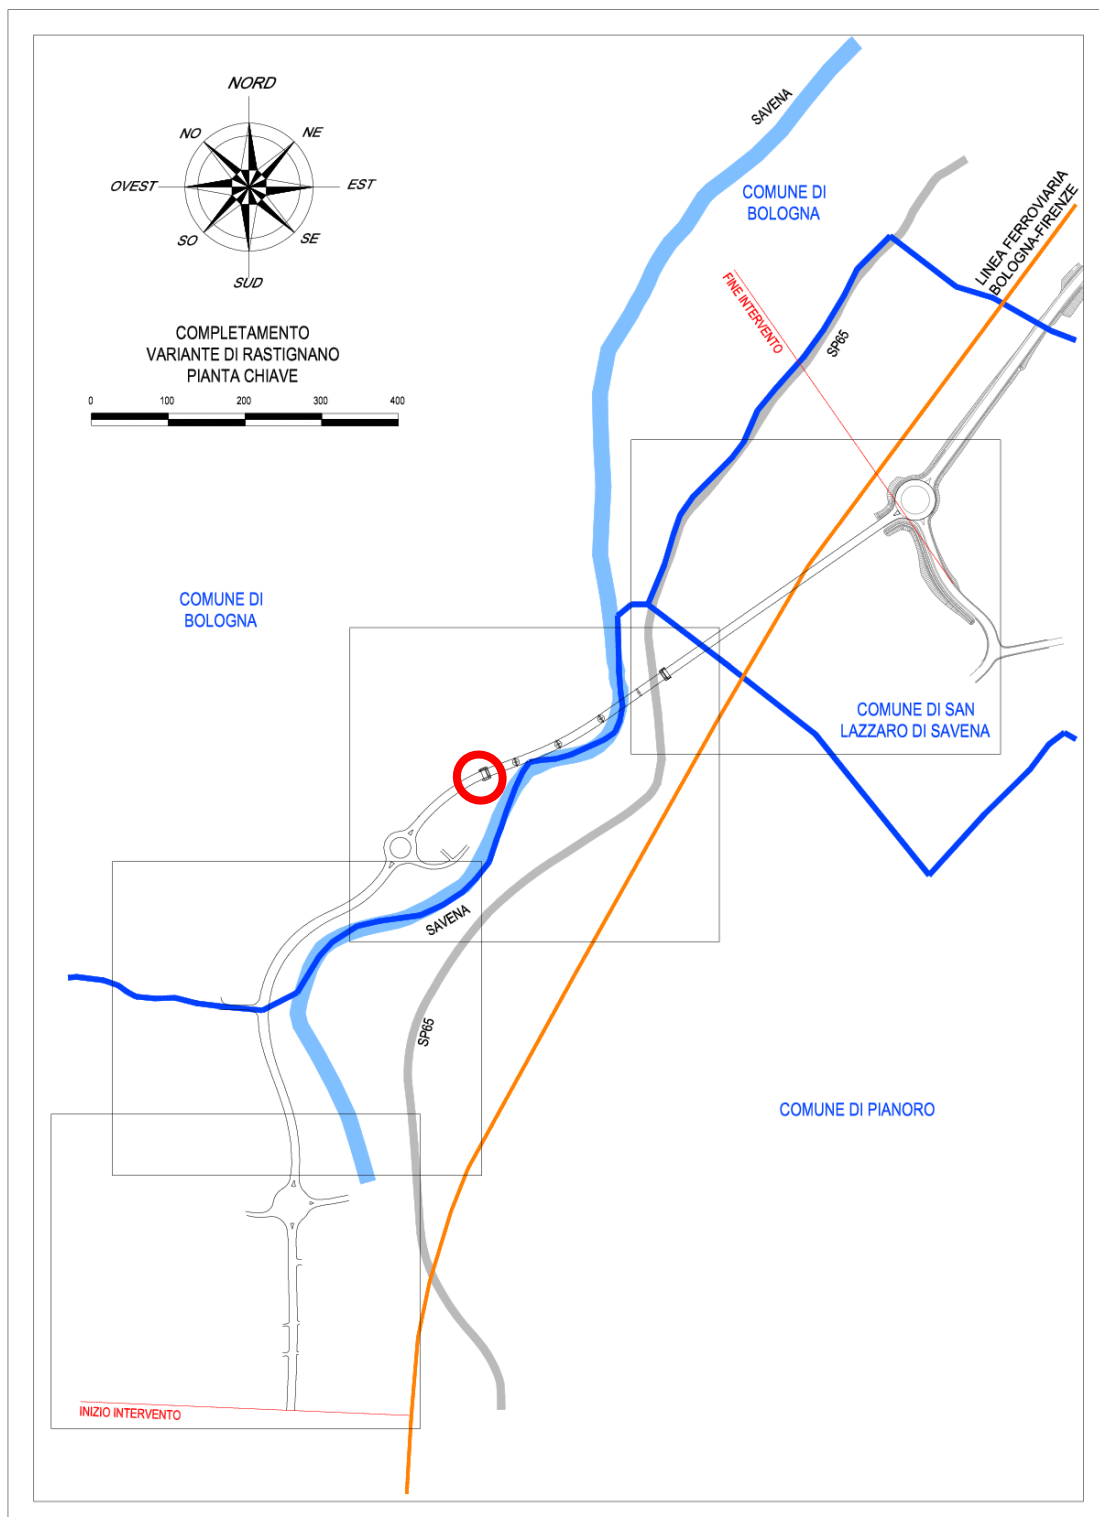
Andamento planimetrico del tracciato e ubicazione dell'opera MS.02
